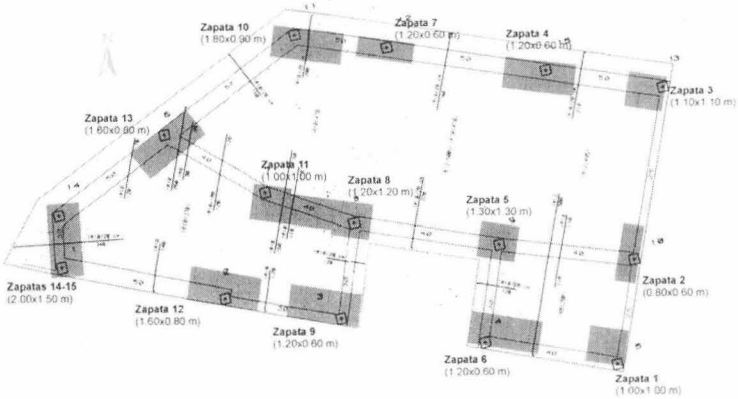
Planta y perfiles del sondeo 3. Localización general de las zapatas de cimentación en la planta del solar.
